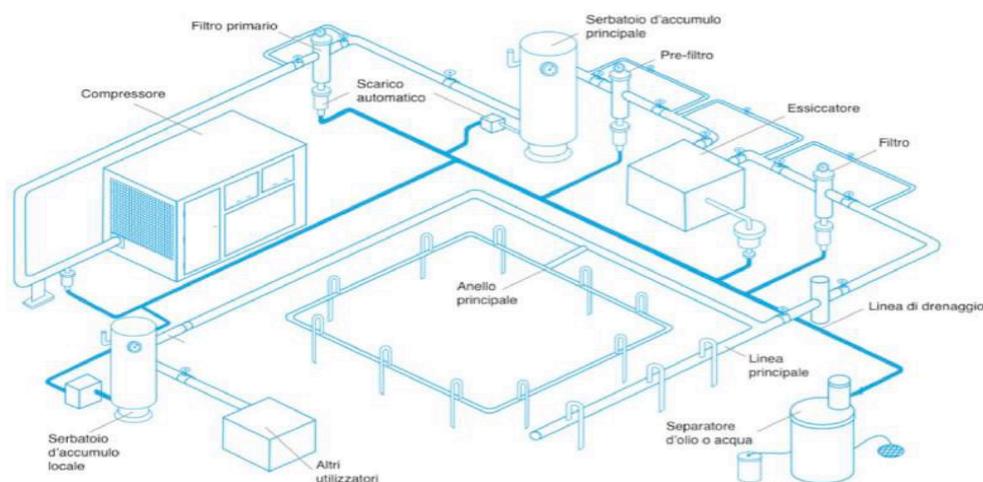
Schema semplificato di un impianto di produzione e distribuzione dell'aria compressa
